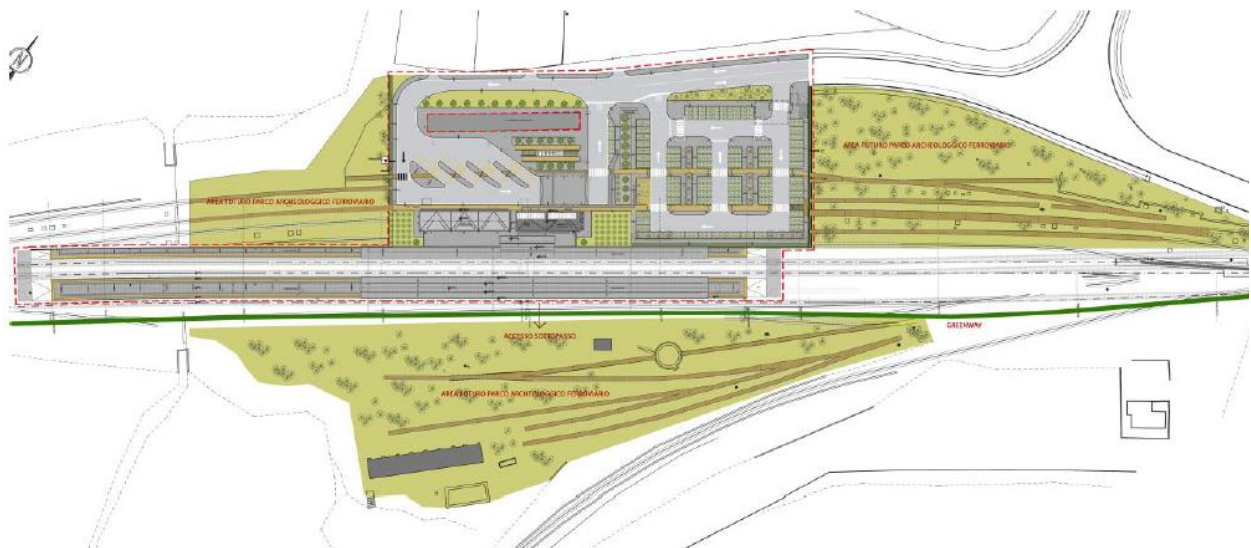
Planimetria generale con indicazione della potenziale futura espansione del parco archeologico - industriale
